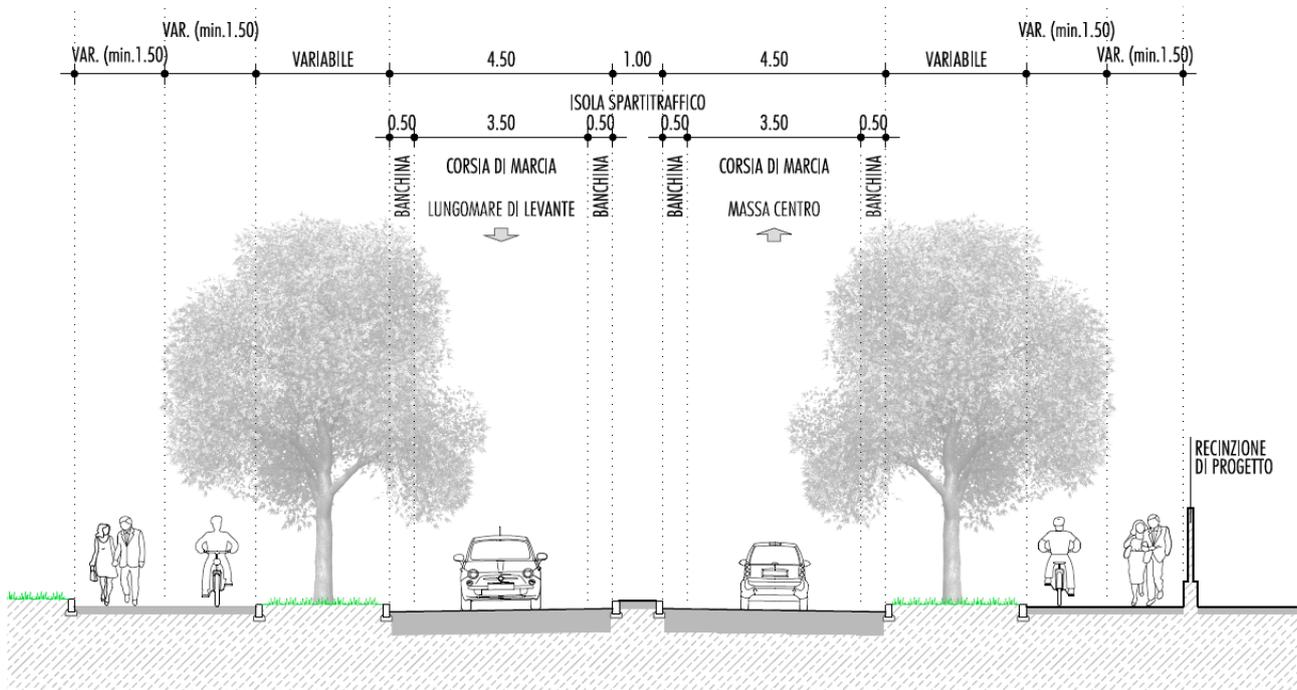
RIFUNZIONALIZZAZIONE DI VIALE ROMA NEL TRATTO ANTISTANTE VIALE VILLETTE– SEZIONE TIPO
